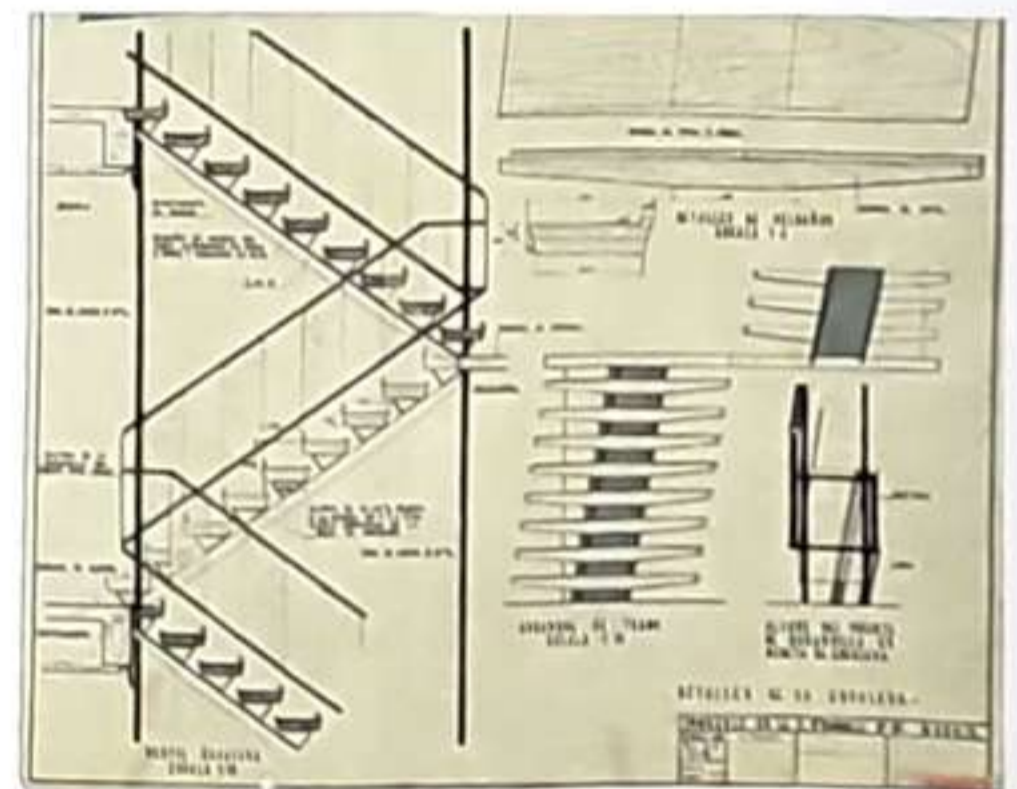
Plano de alzado, sección y desarrollo del diseño original de escalera para el Edificio O'Donnell 33 © Estudio LAMELA.
